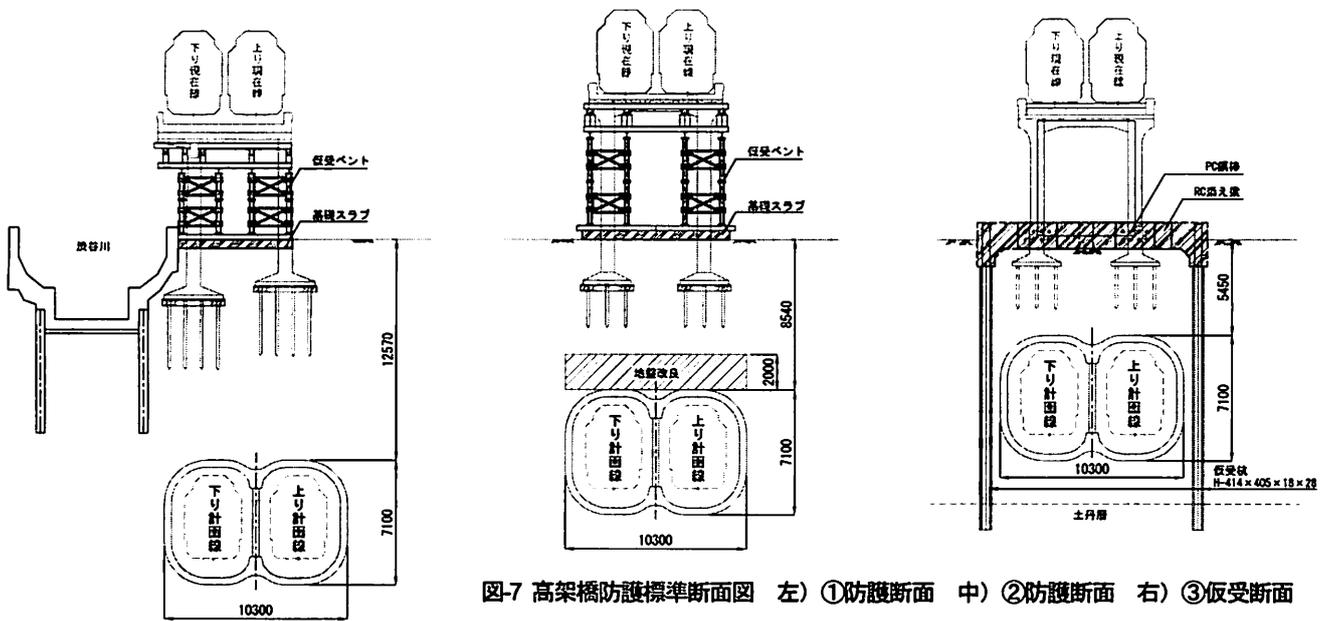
高架橋防護標準断面図 左) ①防護断面 中) ②防護断面 右) ③仮受断面
